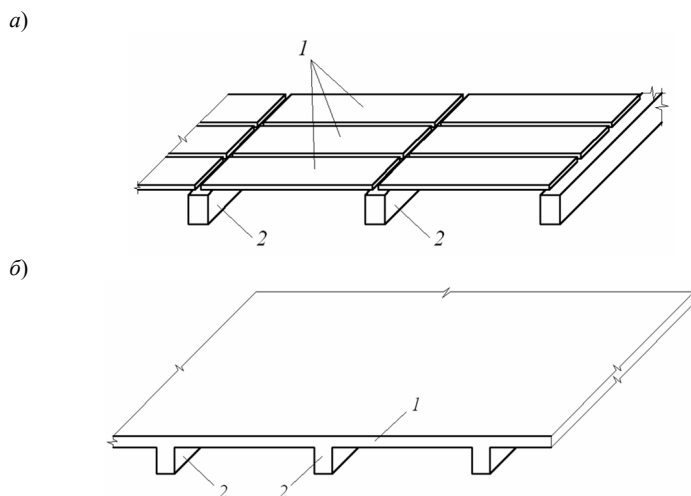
Схемы перекрытий из железобетонных элементов:
